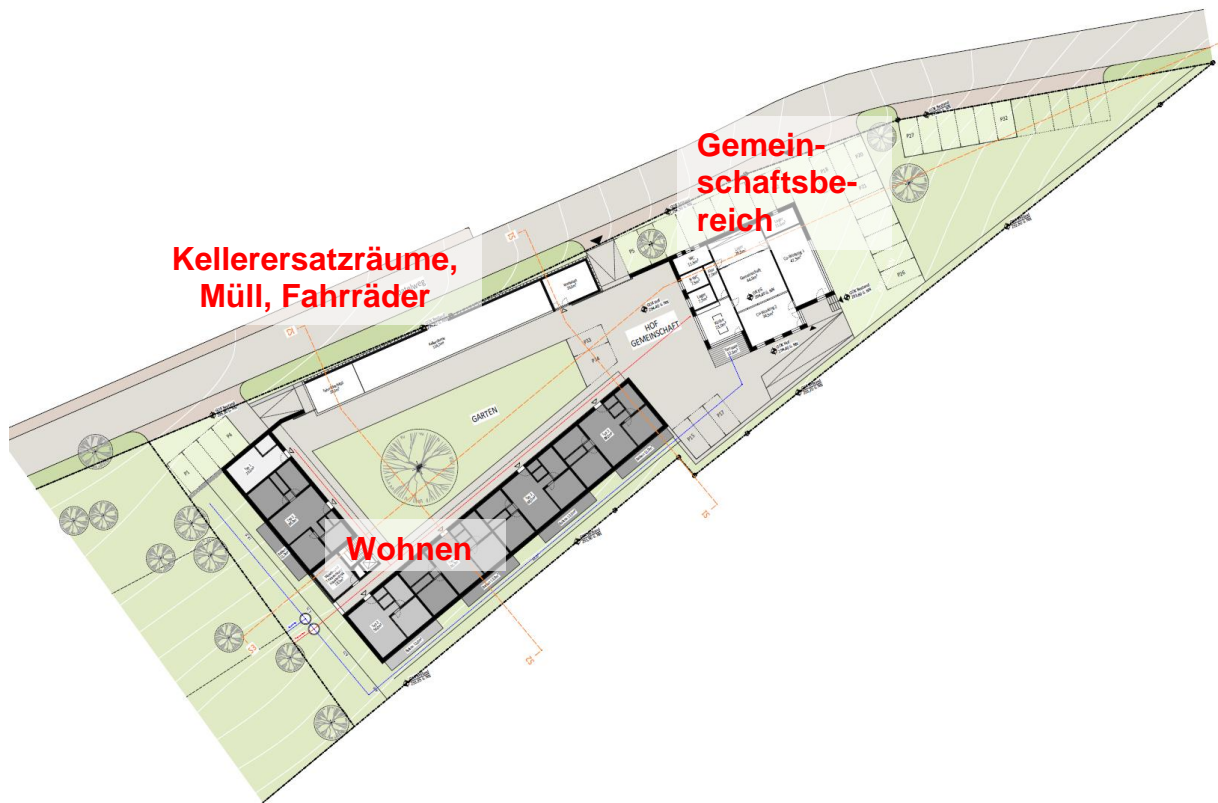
Grundriss Wohnkulturhof (Quelle: Stein Hemmes Wirtz, Stand 28.07.2021)
